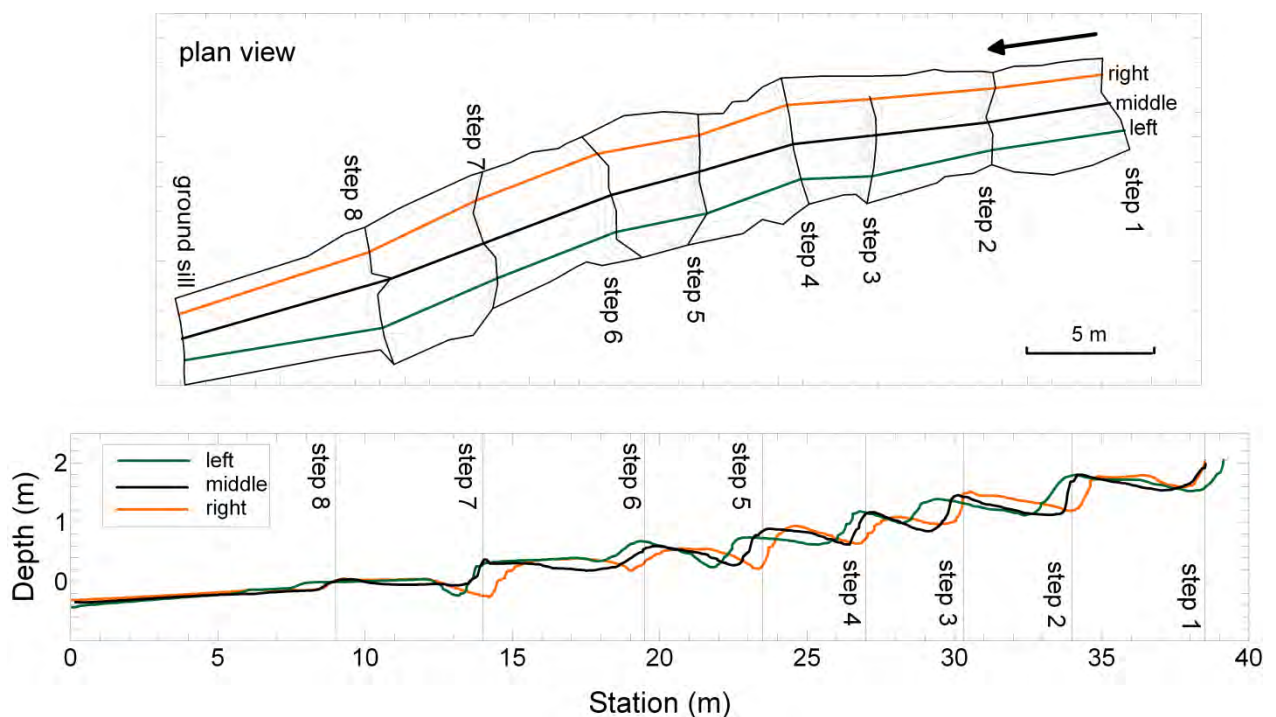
Pendelrampe Stübingbach, Sohlvermessung, Dezember 2009: Grundriss der Rampe (oben), Längenschnitte (unten, 2-fach überhöht)
